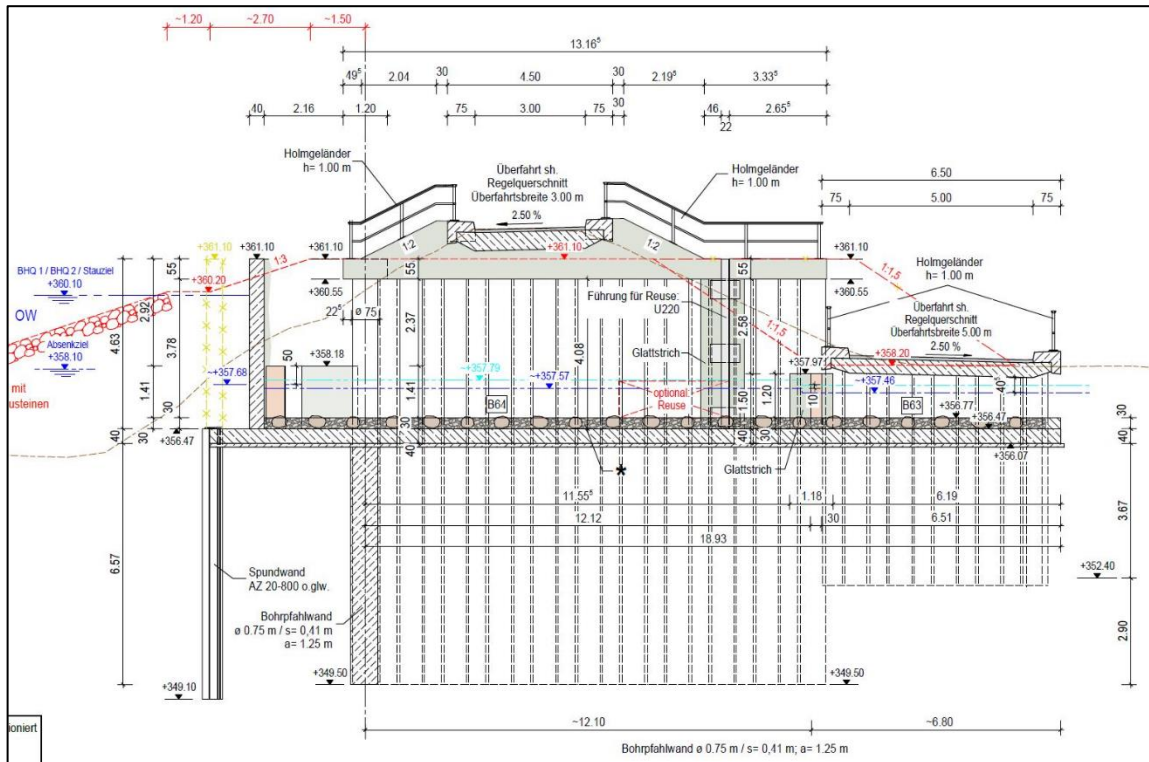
Abmessungen Ausstiegsbauwerk Durchstich – Bereich Becken 64
